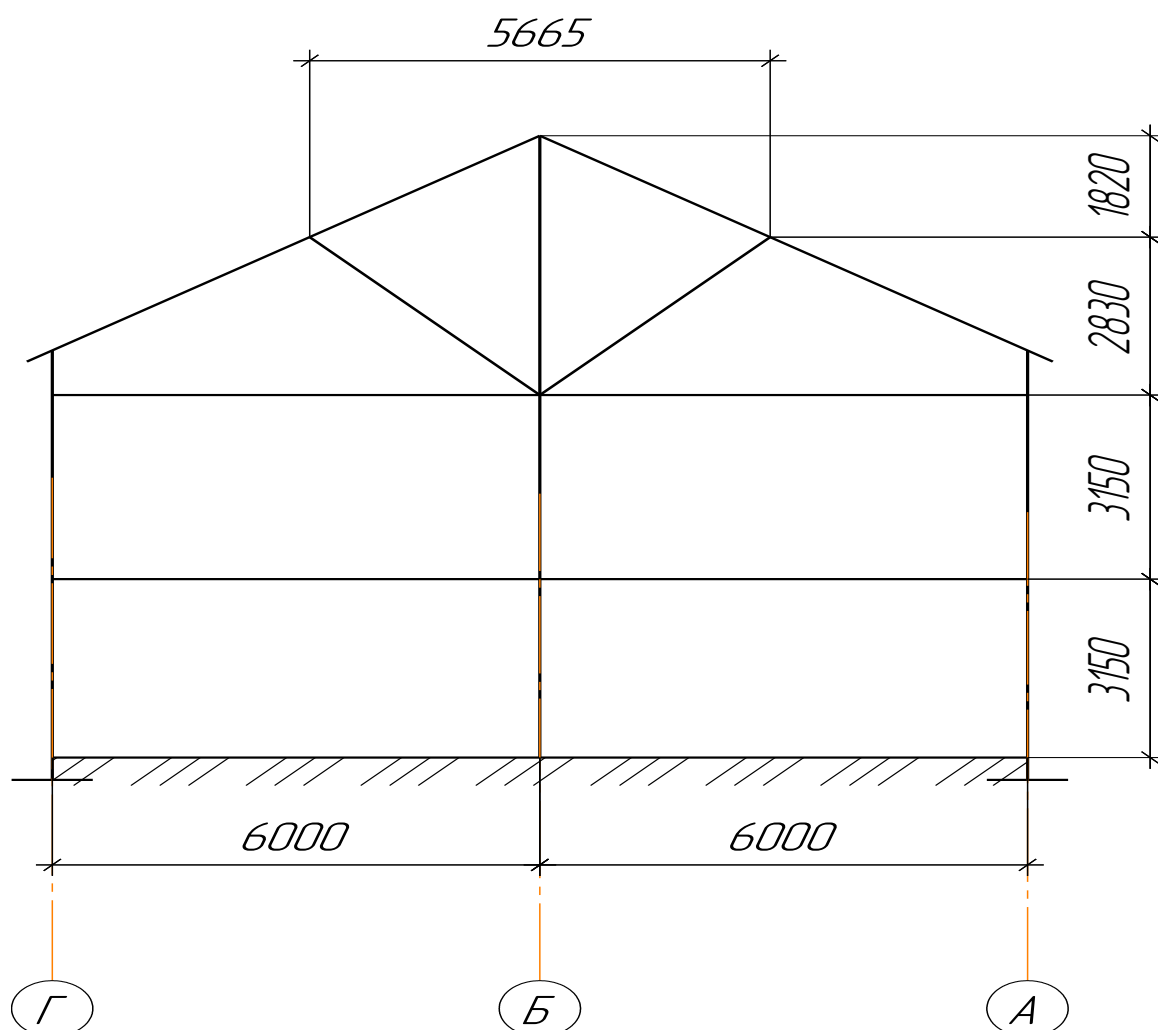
Схема поперечного разреза здания в осях А-Г
